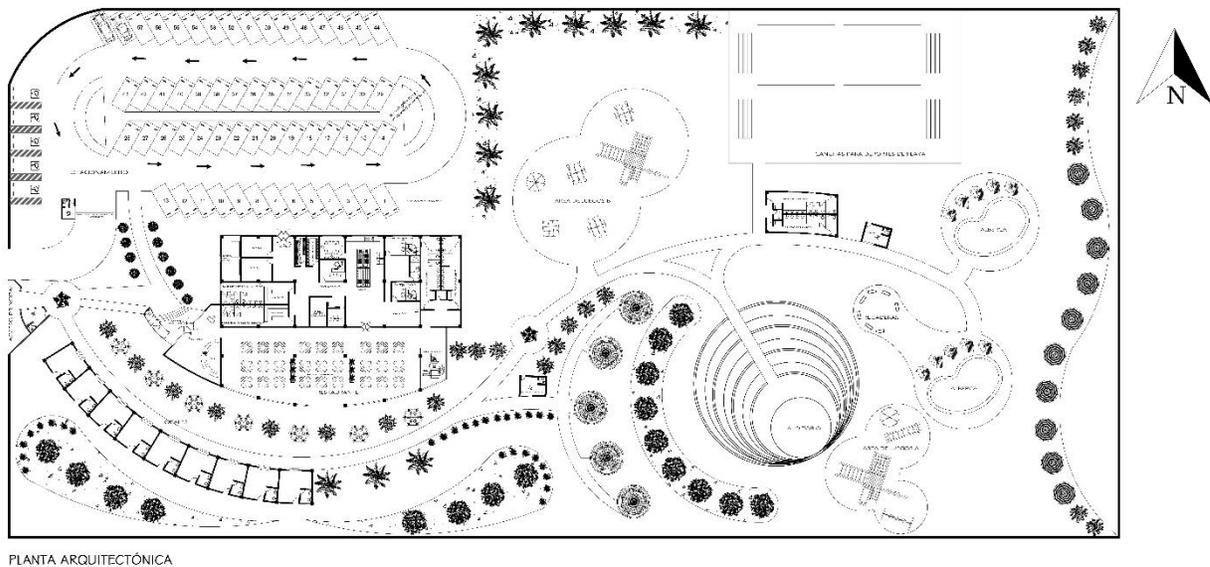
Planta arquitectónica del Centro Recreativo y Turístico
